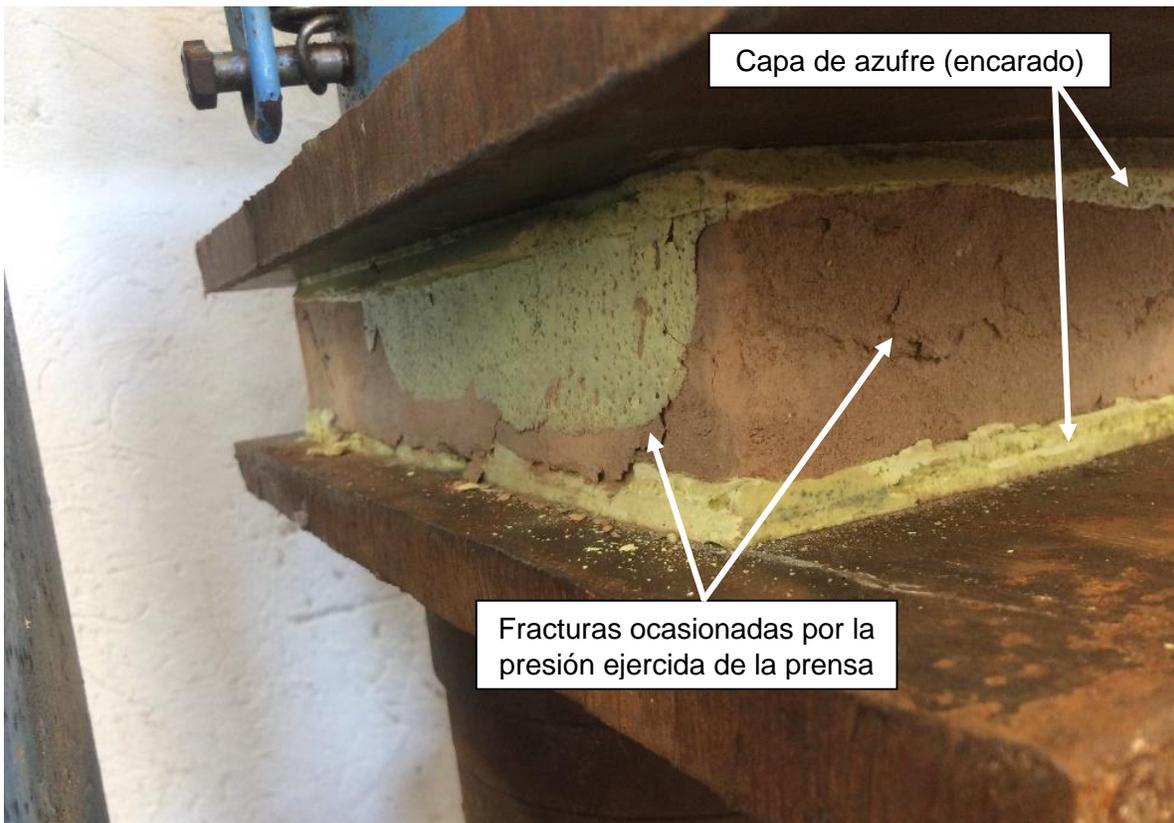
57 Fracturas ocasionadas después de someter el tabique a la prueba de resistencia.
